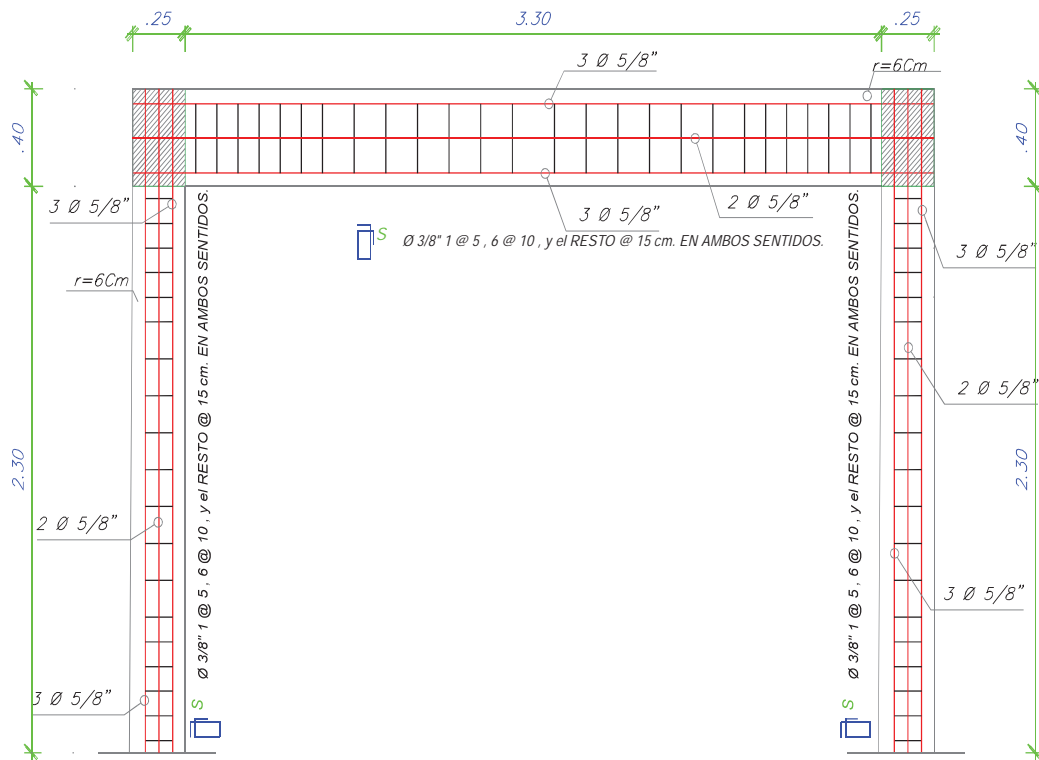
Vista en elevación del pórtico donde se determinó la distribución de los refuerzos de acero, eje C2-C3. (Elaboración propia)
